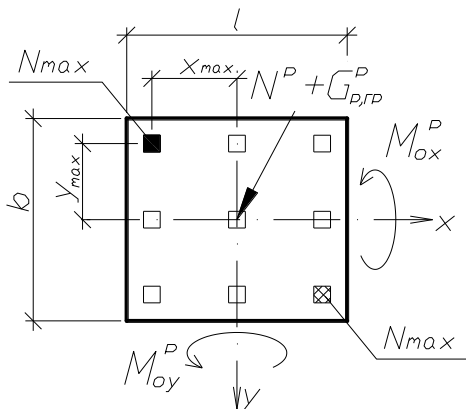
Схема к определению максимальной и минимальной расчетных нагрузок на сваи
